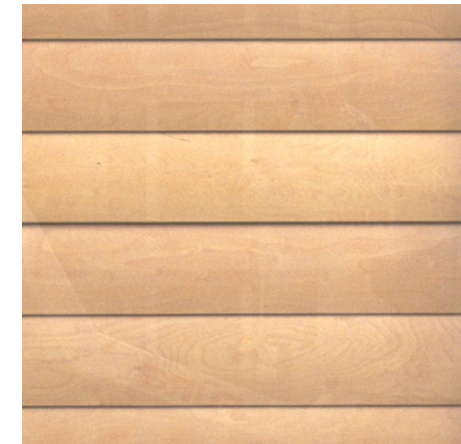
Holz-Lamelle geschlossen, Außenansicht
